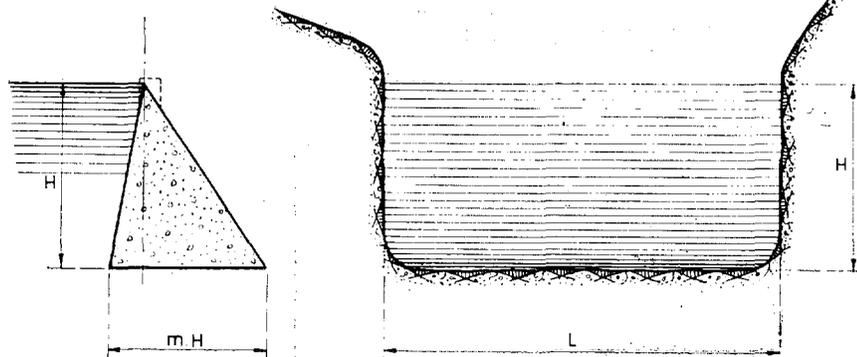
ª— Solución de presa de gravedad para una cerrada en forma de U.
